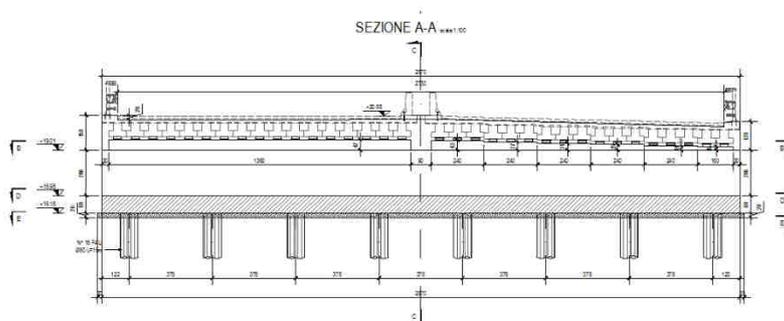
Spalla B prospetto Ponte - Rio Salius deviato
